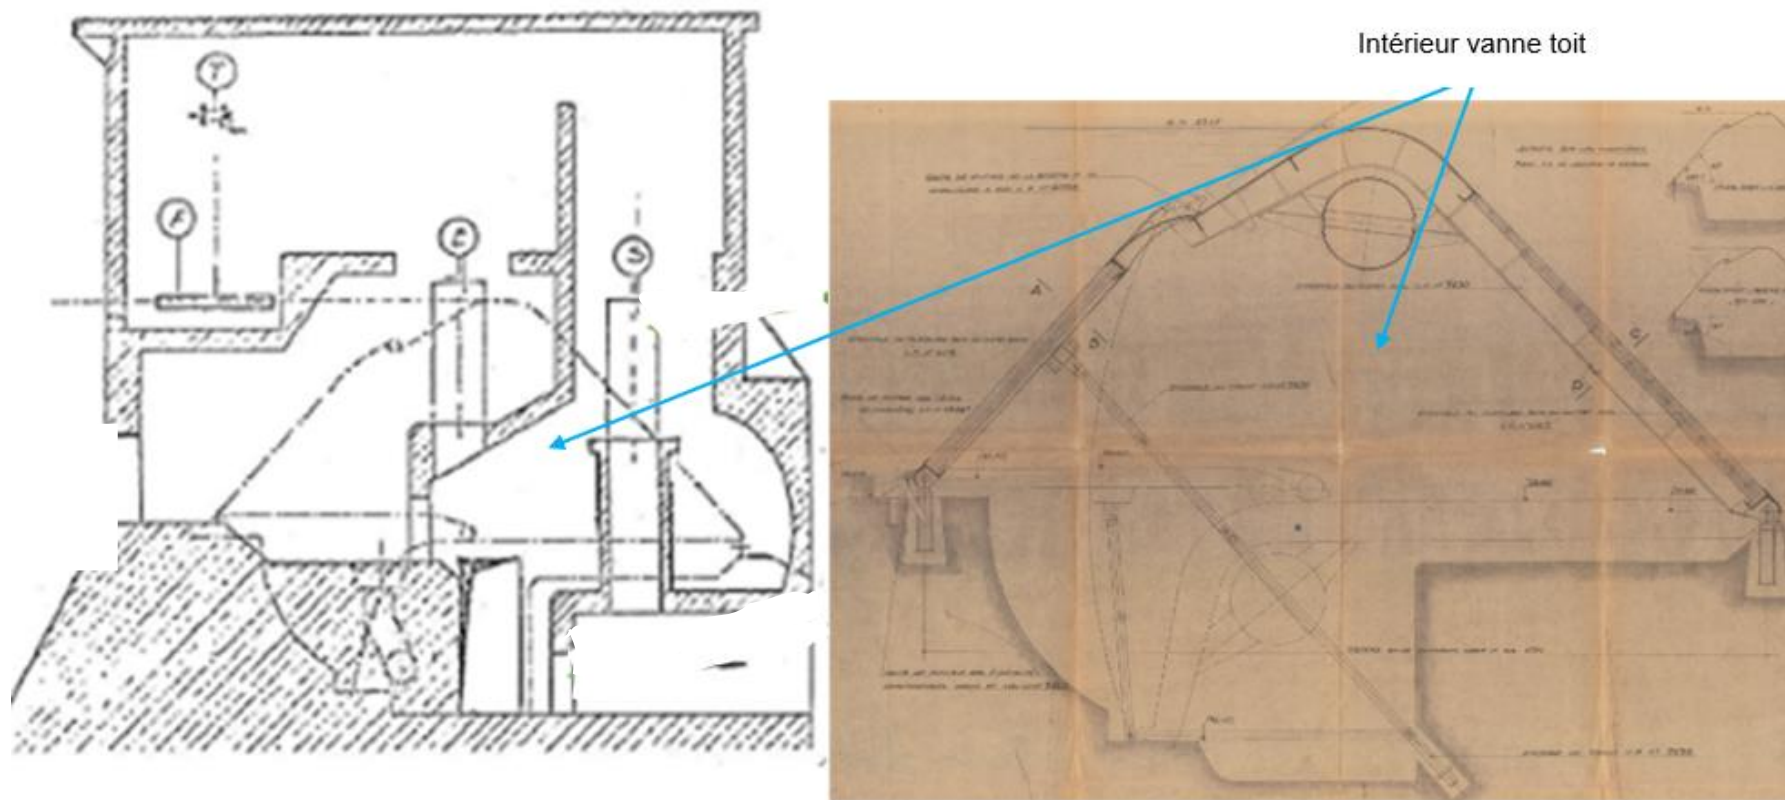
Localisation des travaux à l'intérieur des vannes toits sur une vue en coupe.
